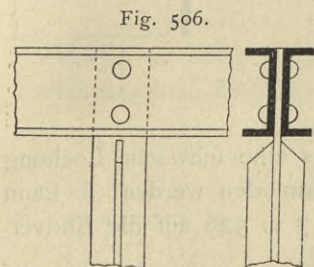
zeigt den unmittelbaren Anschluß einer solchen +-Steife an die aus zwei C-Eisen mit Schlitz gebildete Gurtung eines Trägers.
